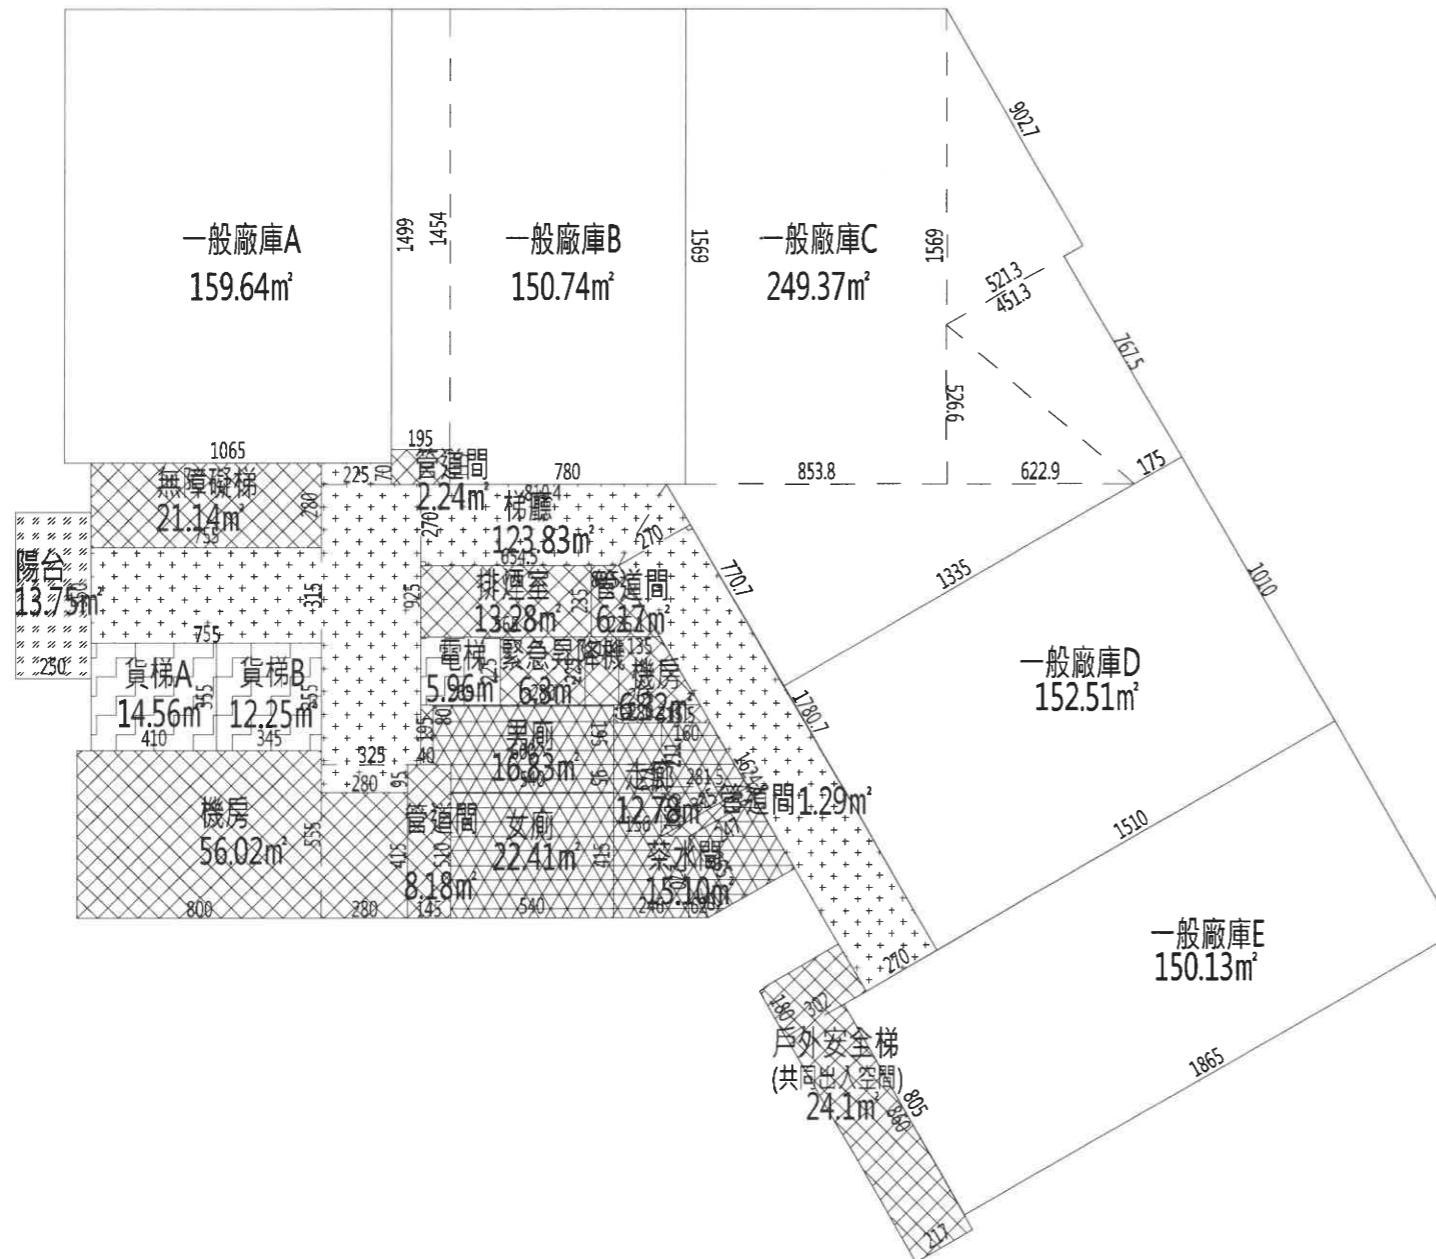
地上六層平面圖(變更後)(S : 1/300)
